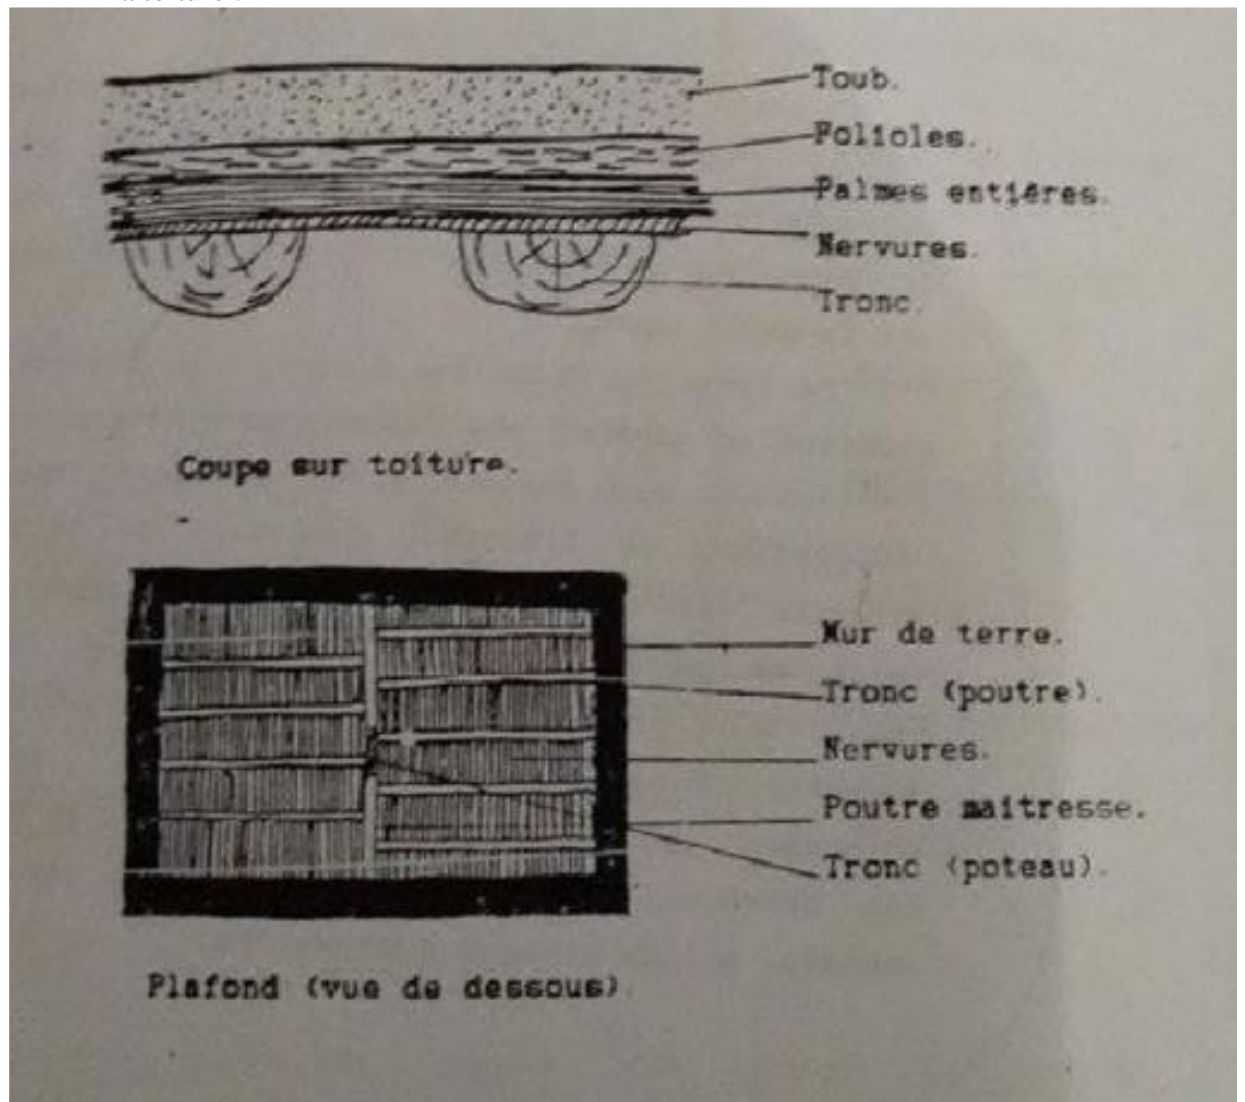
Photo :présente la toiture d'une maison traditionnelle
